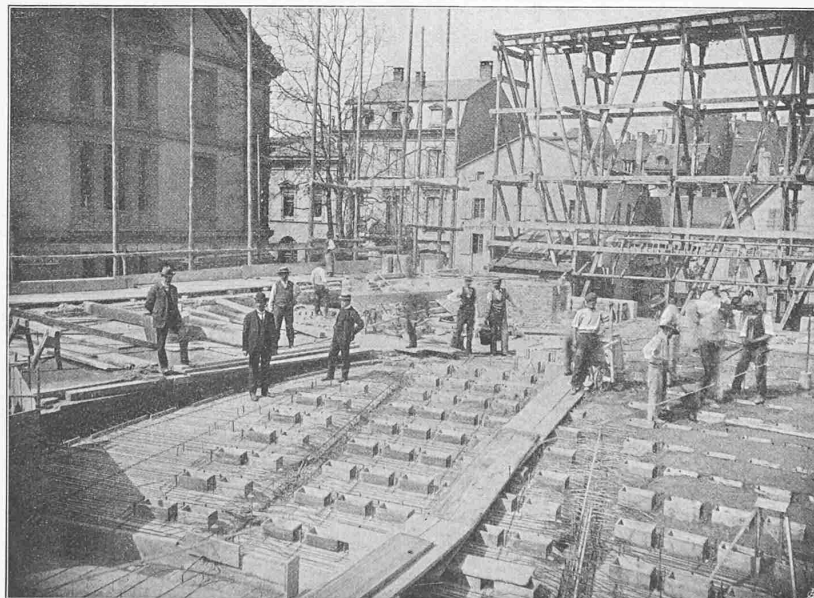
Blick auf den Parterrefussboden während der Betonierung.
